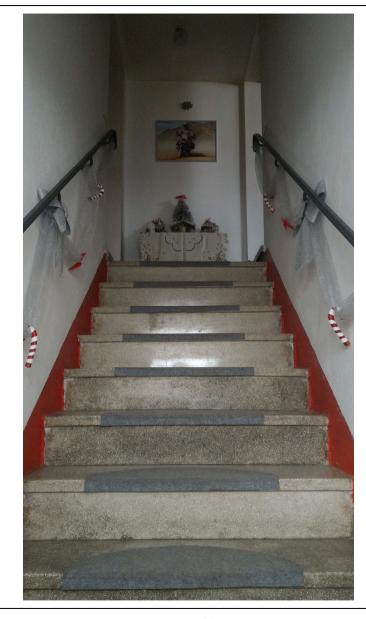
vista della scala principale di collegamento tra piano terra e primo
